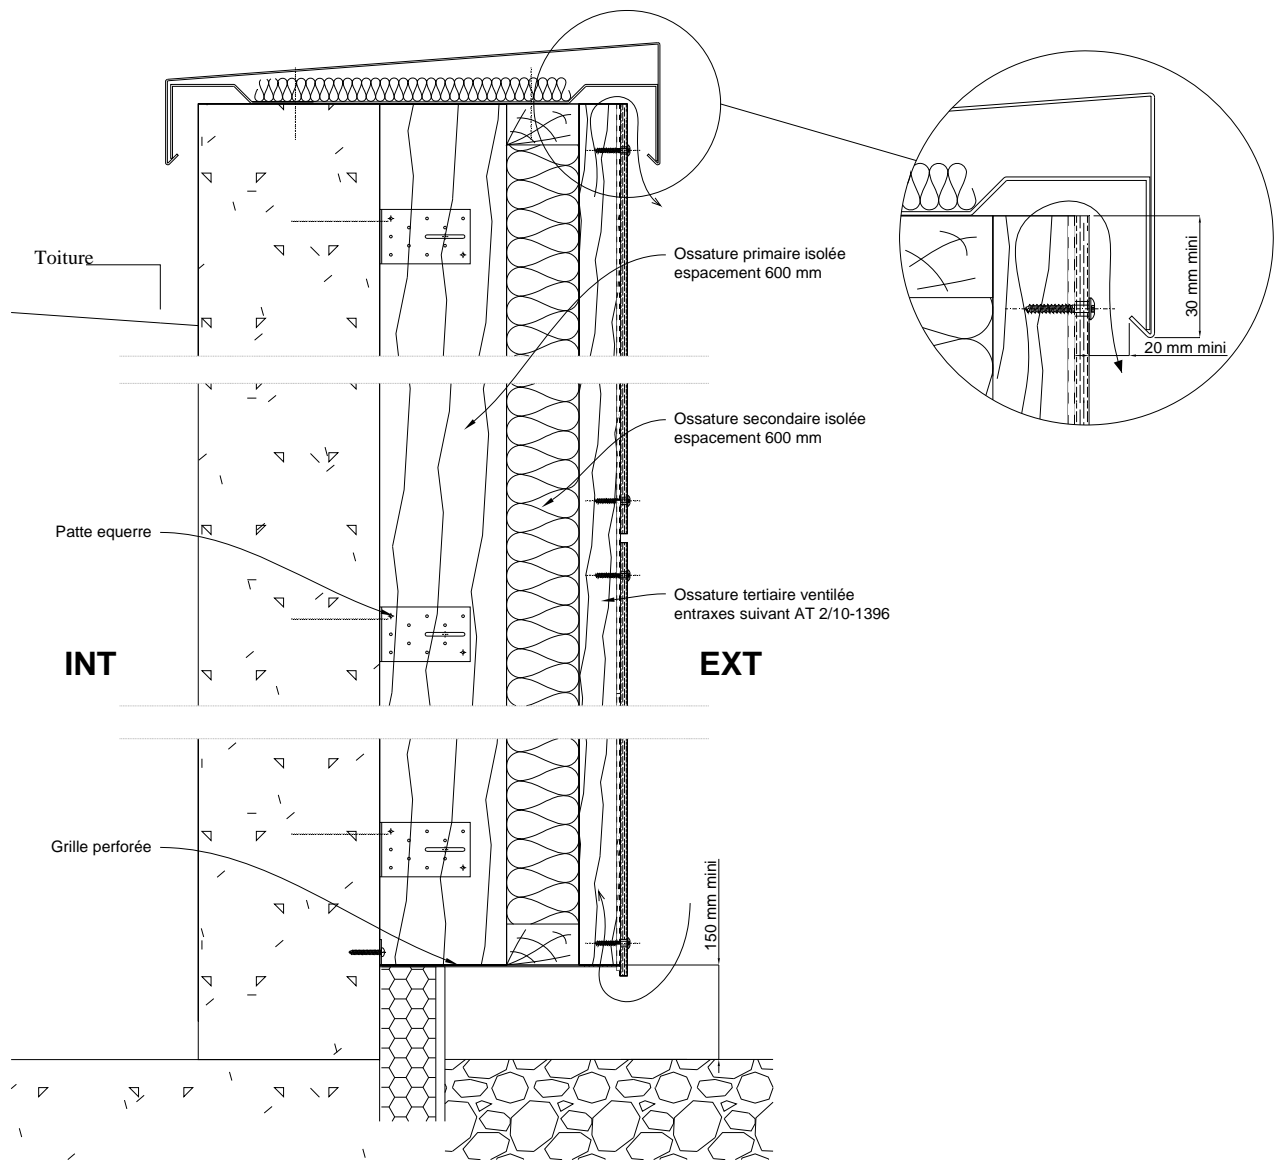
Réseaux croisés sur BA - Coupe verticale générale
